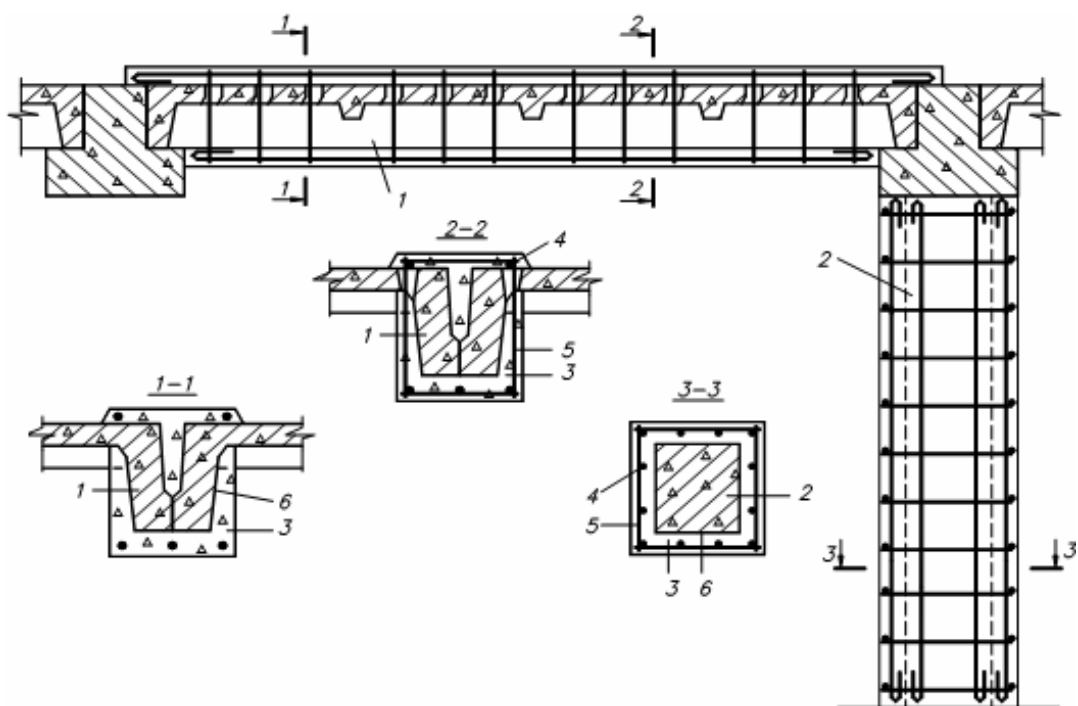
Усиление ребристых плит и колонны железобетонной обоймой:
